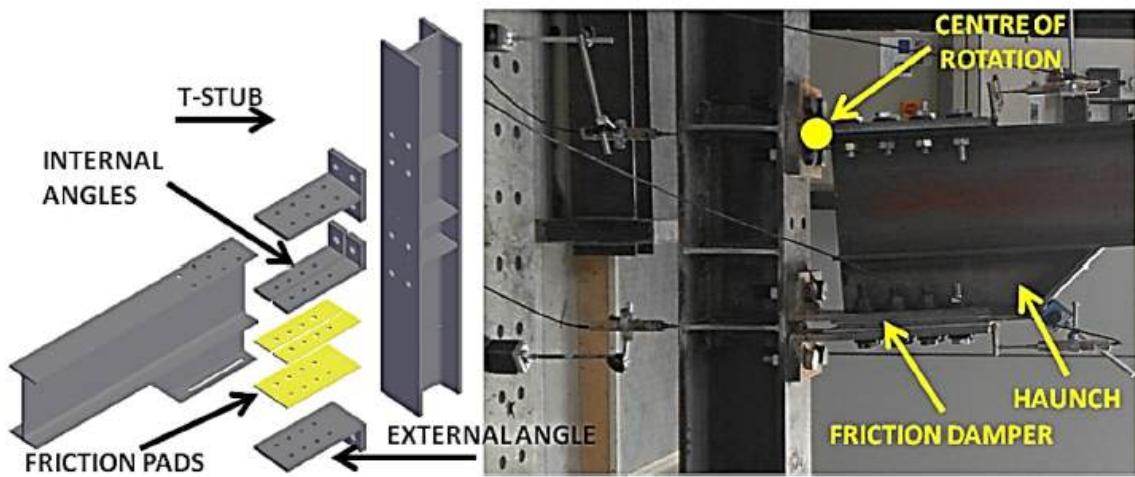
Liaison poutre-poteau équipée d'amortisseurs à friction et d'un renfort supplémentaire [63]
